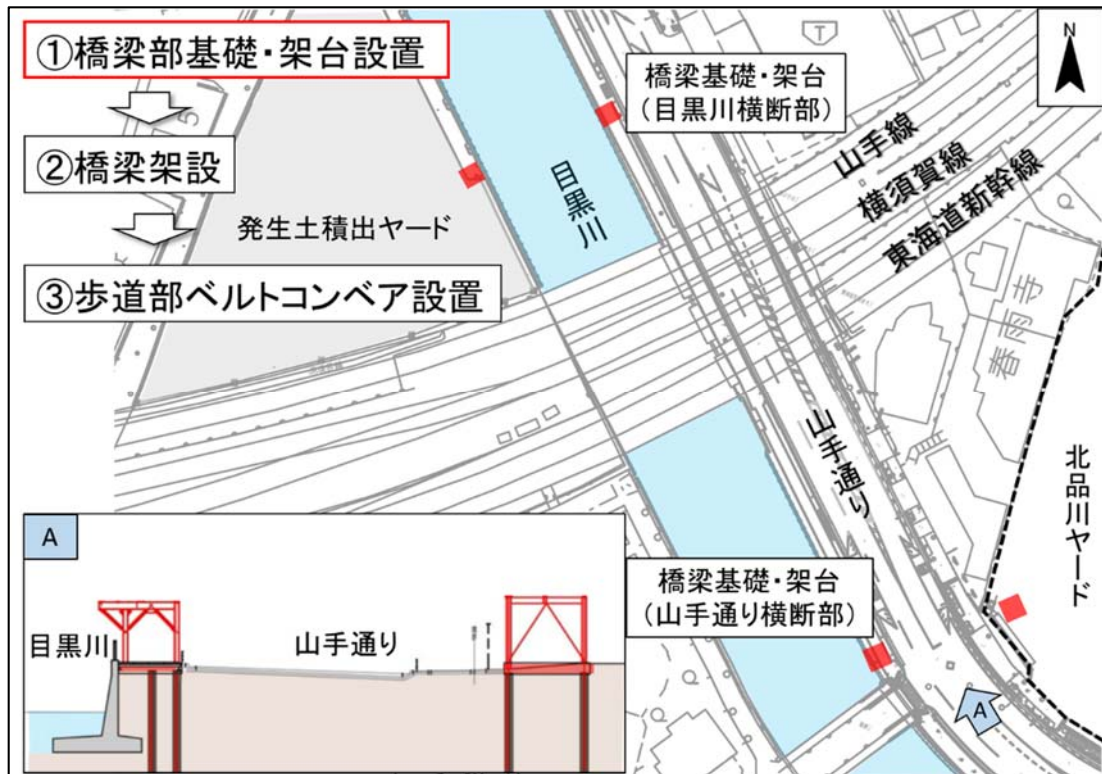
ベルトコンベア設置の施工手順 (①橋梁部基礎・架台設置)
